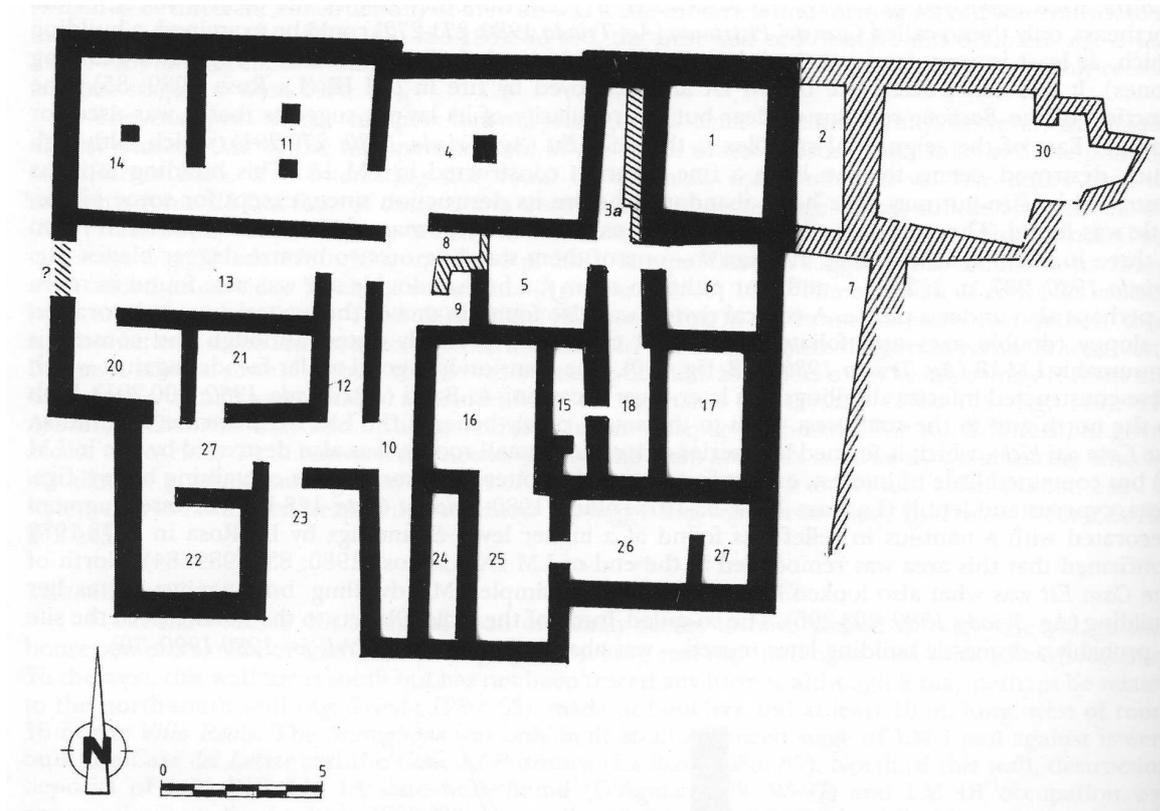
Kania, Grundrissplan nach J. Driessen – C. F. MacDonald.
